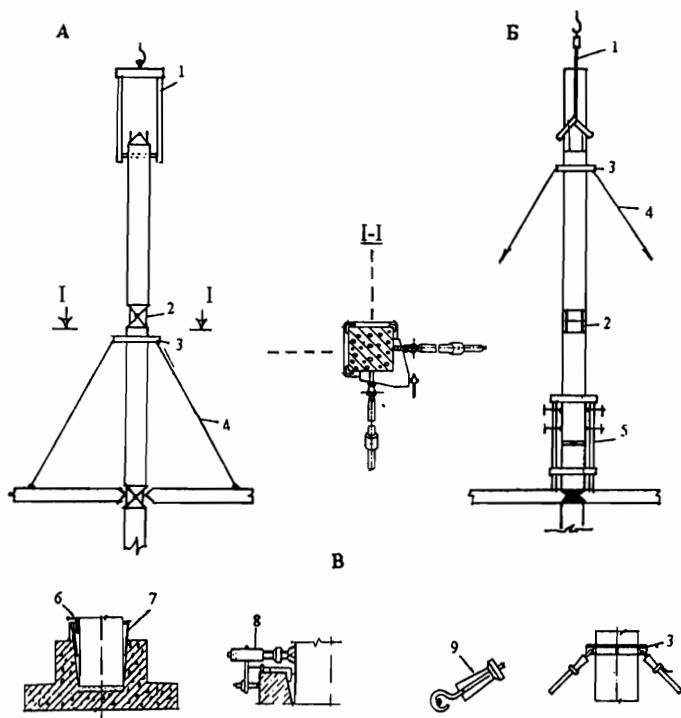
Варианты монтажа колонн (А, Б) и приспособления для выверки и временного закрепления (В); 1 – захват для подъема колонны; 2 – место стыковки с надколонной плитой; 3 – хомут для крепления расчалок к колонне; 4 – распорки-расчалки; 5 – одиночный кондуктор; 6 – клиновидный вкладыш; 7 – клинья (стальные, железобетонные, деревянные); 8 – домкрат для корректировки положения колонн; 9 – винтовая натяжка расчалок
